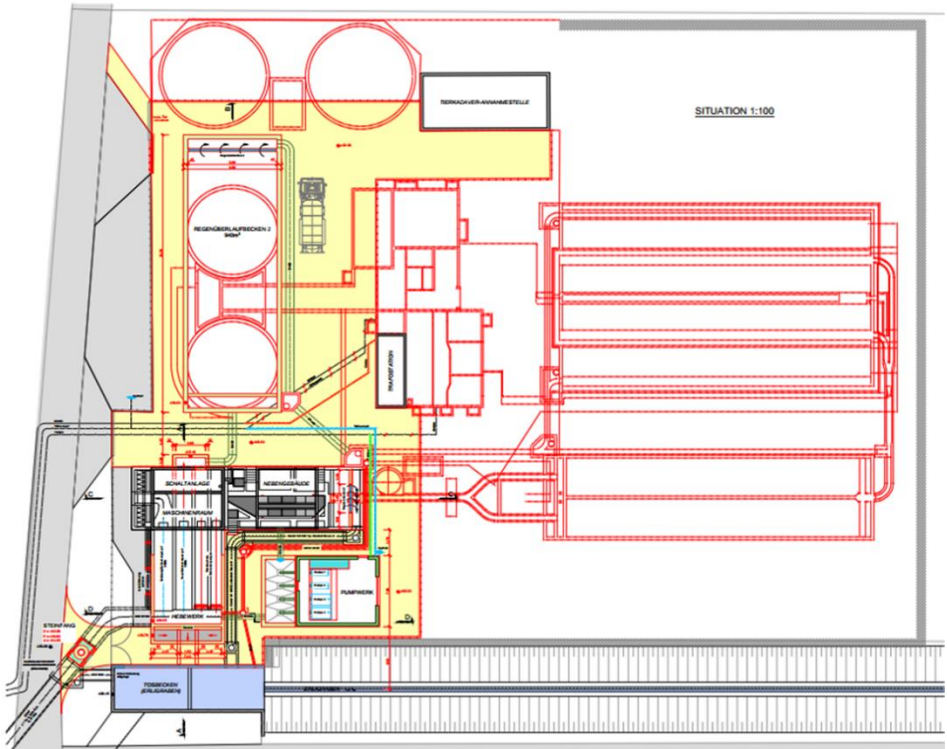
Die umgebaute Anlage mit Pumpwerk, Hebewerk und Regenbecken (Rückbau altes Betriebsgebäude, Klärbecken und Schlammbehandlung)
